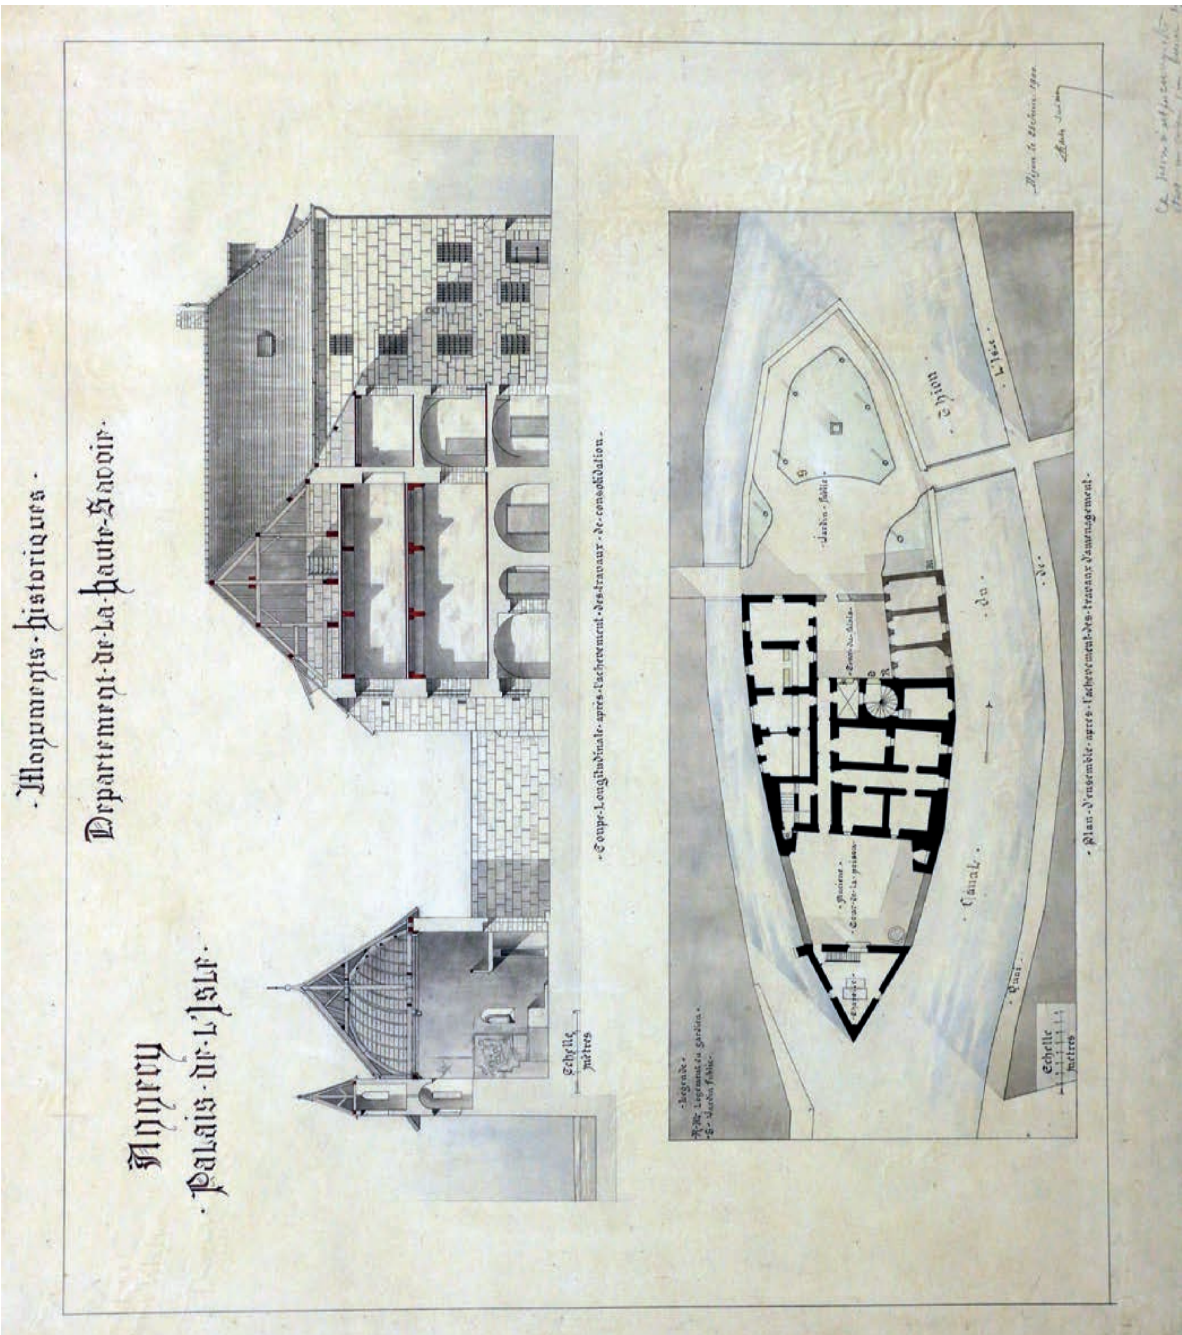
Charles Suisse, Annecy, Palais de l'Isle (23/06/1900). Plan et coupe après l'achèvement des travaux d'aménagement et de consolidation. Médiathèque du patrimoine. 0082/074-Plans d'édition de la Haute-Savoie (028844-002) ;
